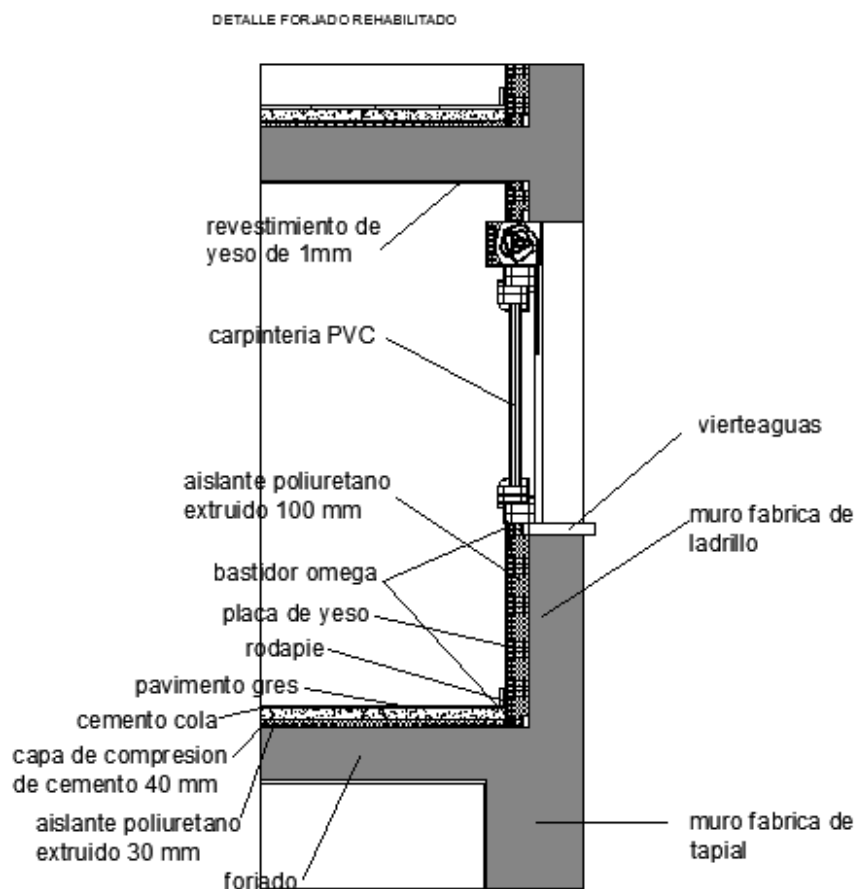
Detalle de aislamiento térmico por el interior de fachada.
